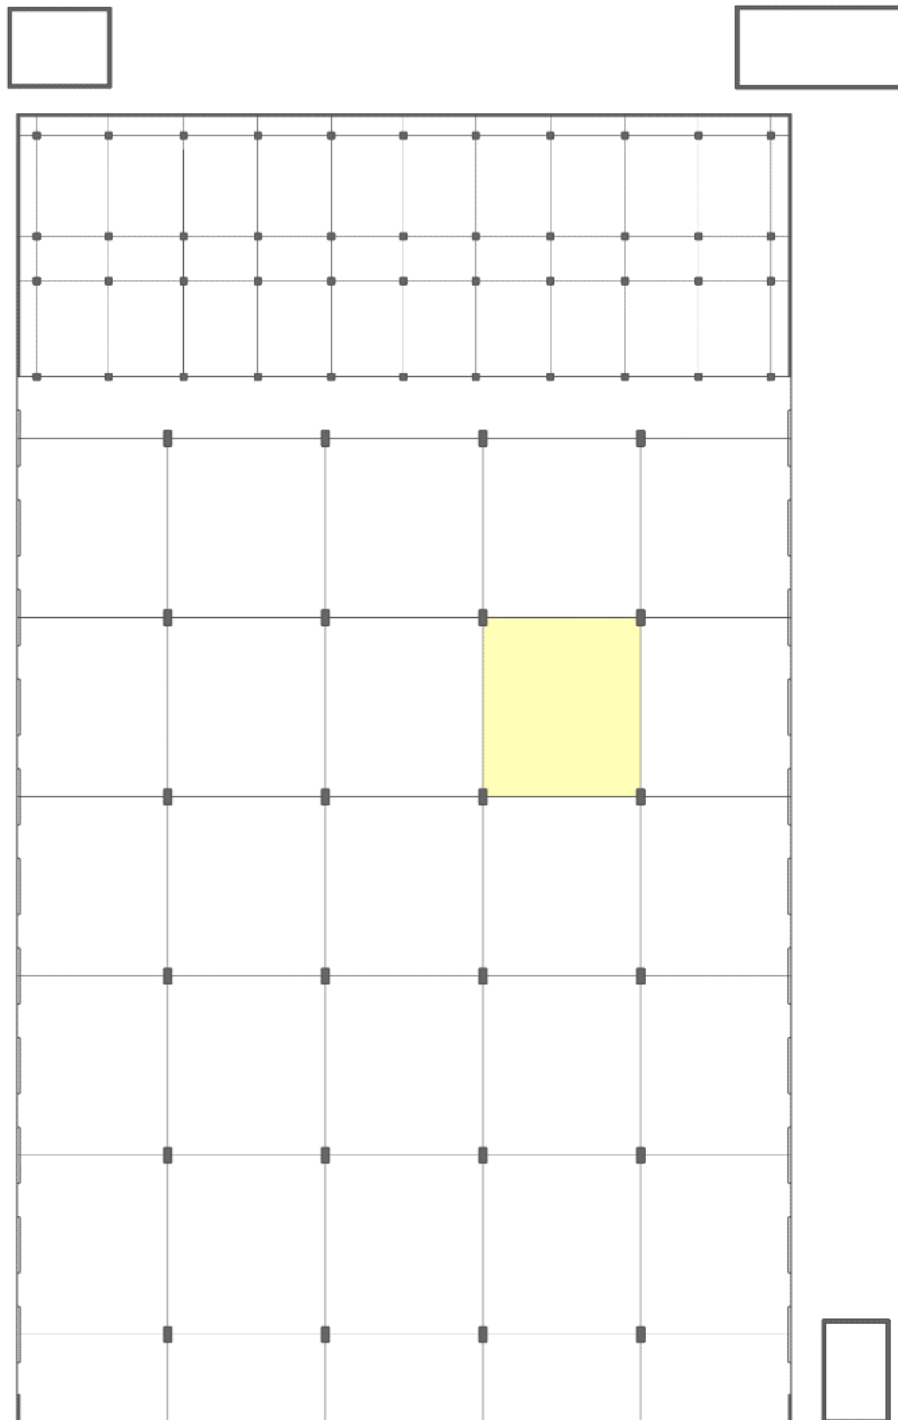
Planta estructural. Módulo Estructural: 14m x 16 m. Fuente: autor.
